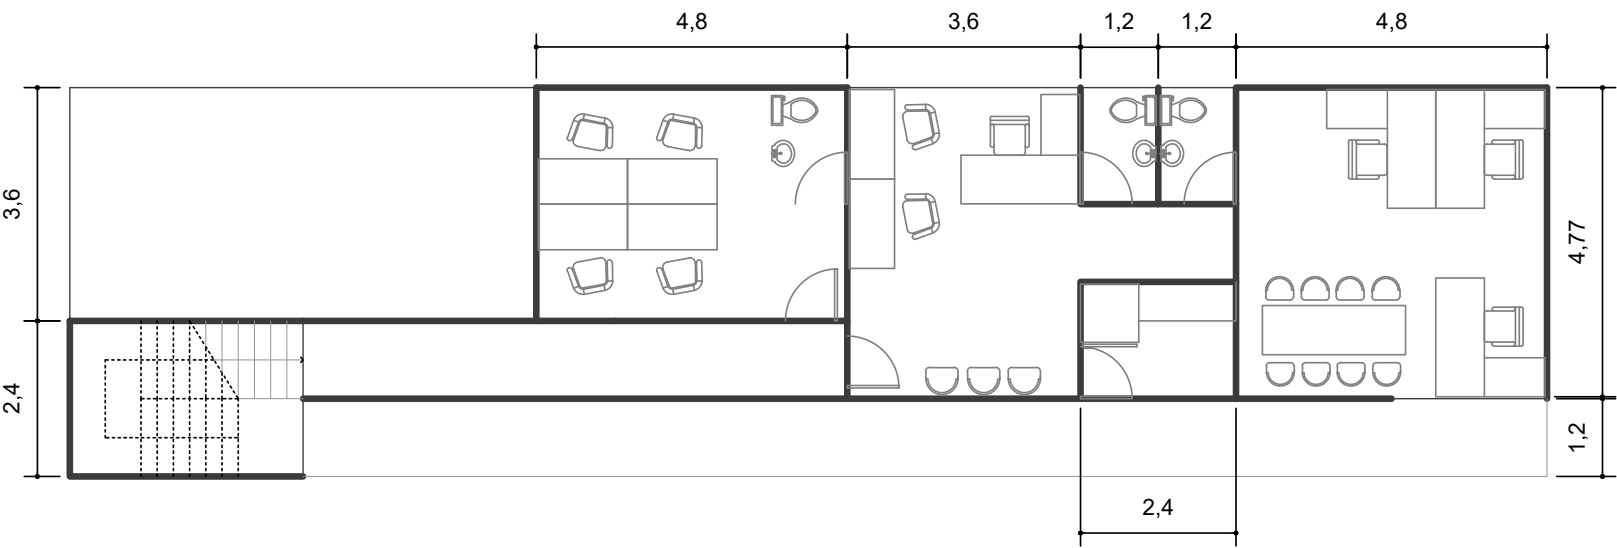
Planta do primeiro pavimento da construção temporária da obra da R. Yasbek
